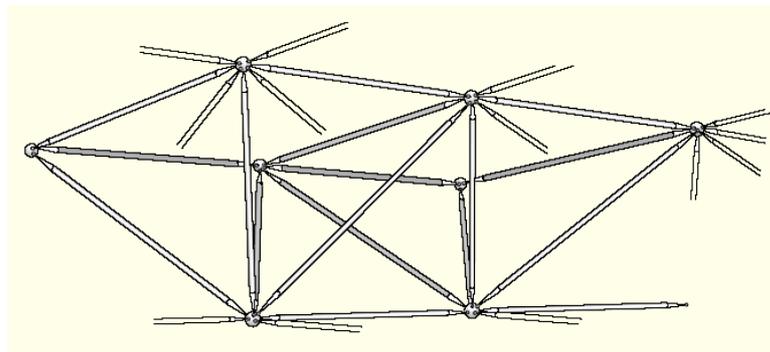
Treliça espacial como sistema auto-contraventado de cobertura[4]
